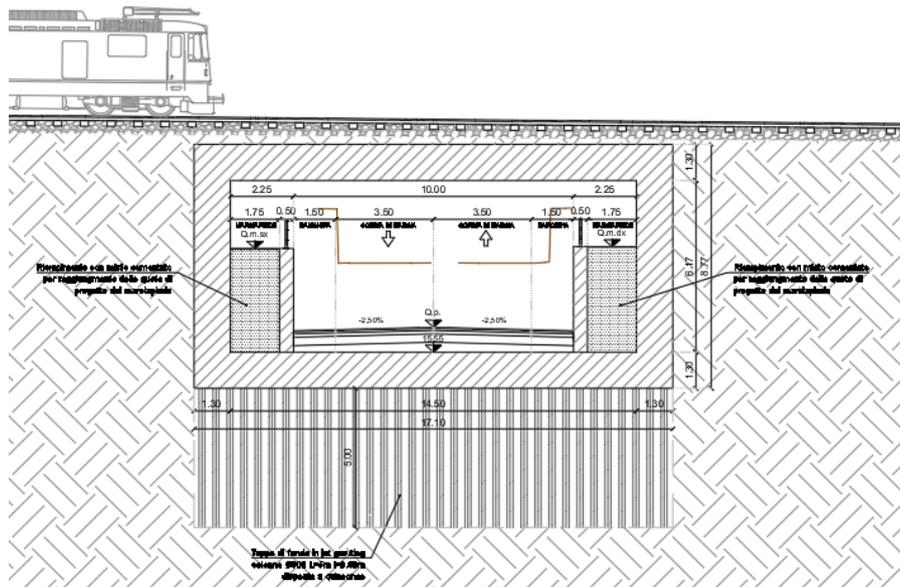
Sottovia ferroviaria – Sezione trasversale sul sottovia
